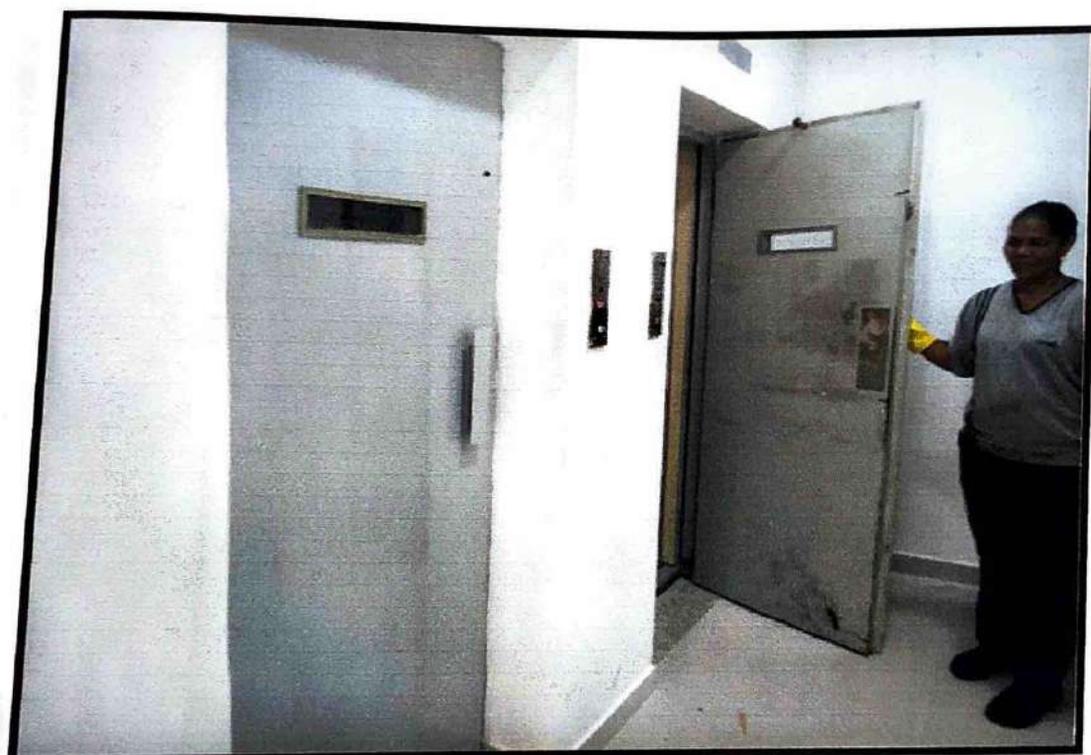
Vista do hall do pavimento térreo do bloco 8, com 02 elevadores.
